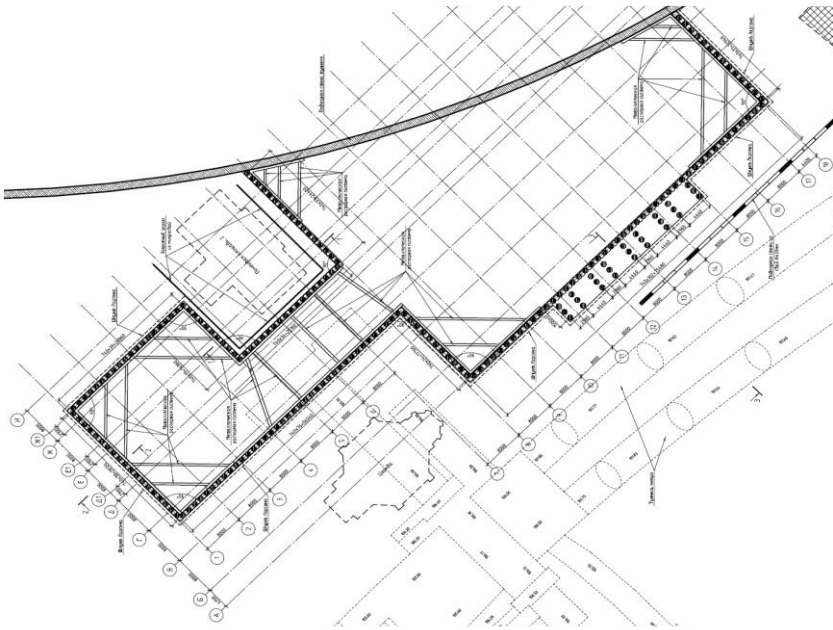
План розташування конструкцій огороження котловану і ближніх будівель: церква Різдва Христового, Поштовий будинок, будівля «Київпаstrансу»
